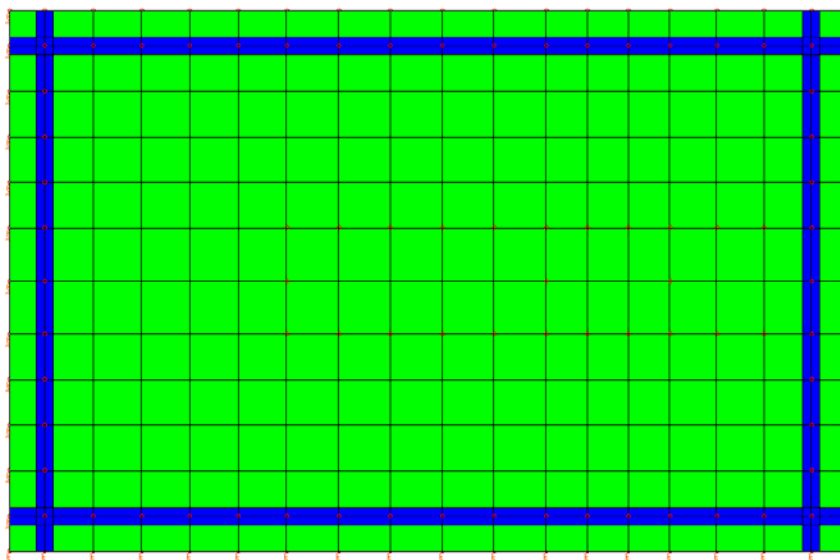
Vista in Pianta Platea e Travi di Fondazione
